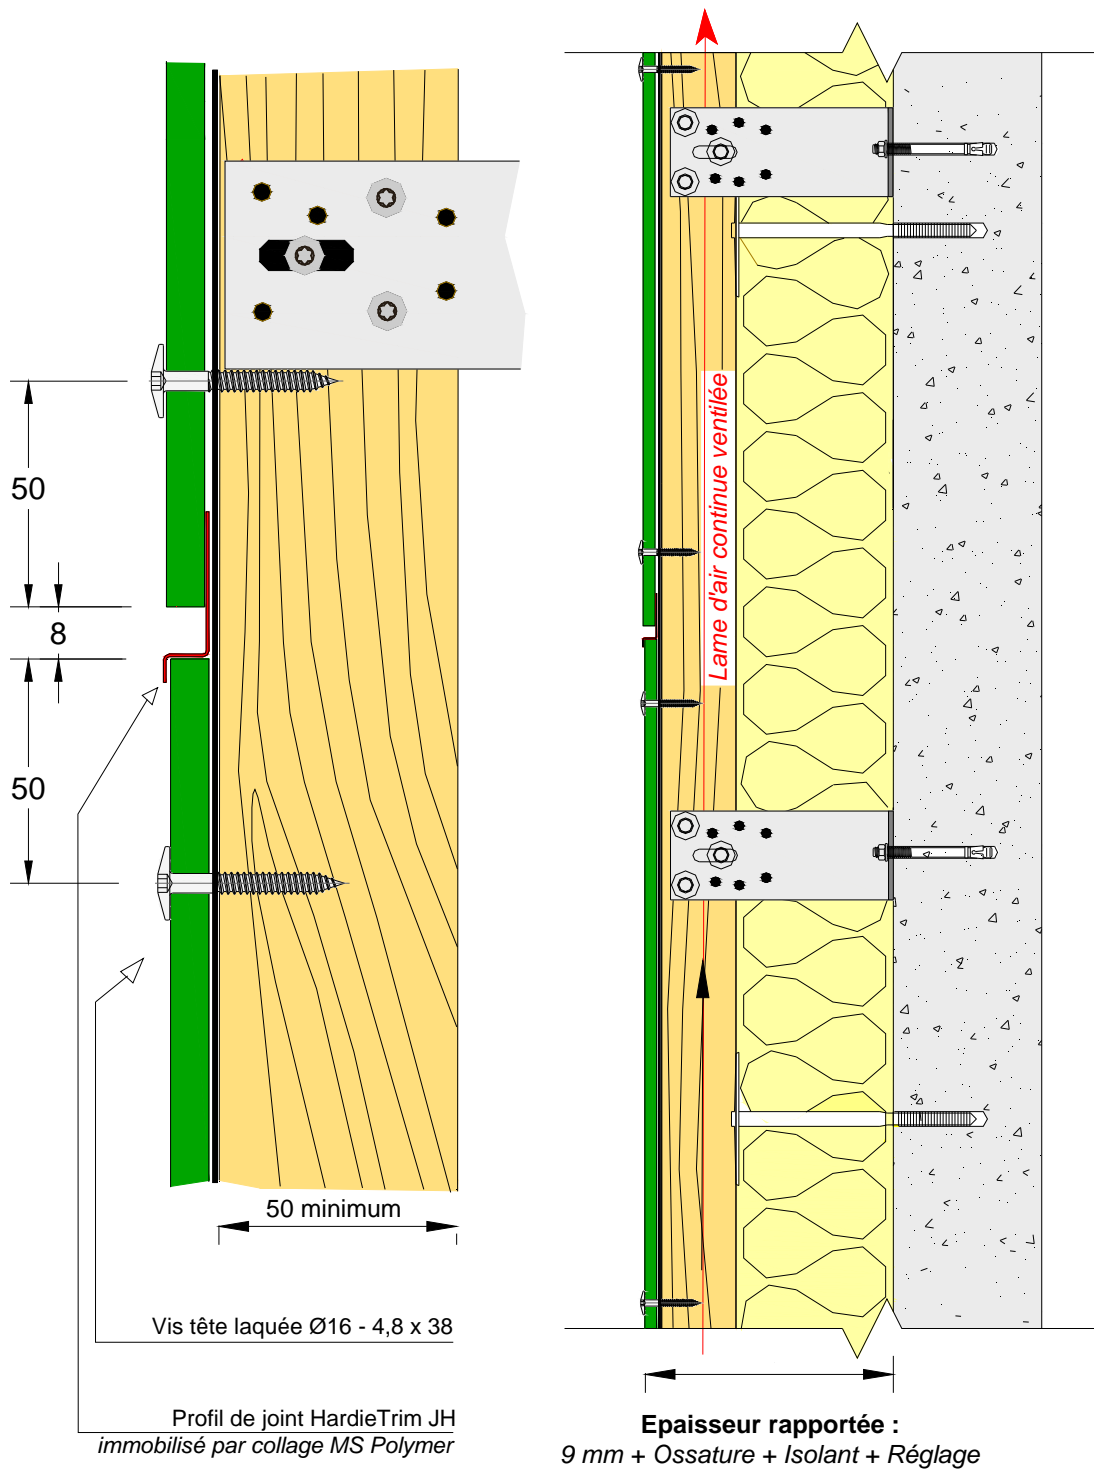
Coupe verticale sur joint horizontal fermé
